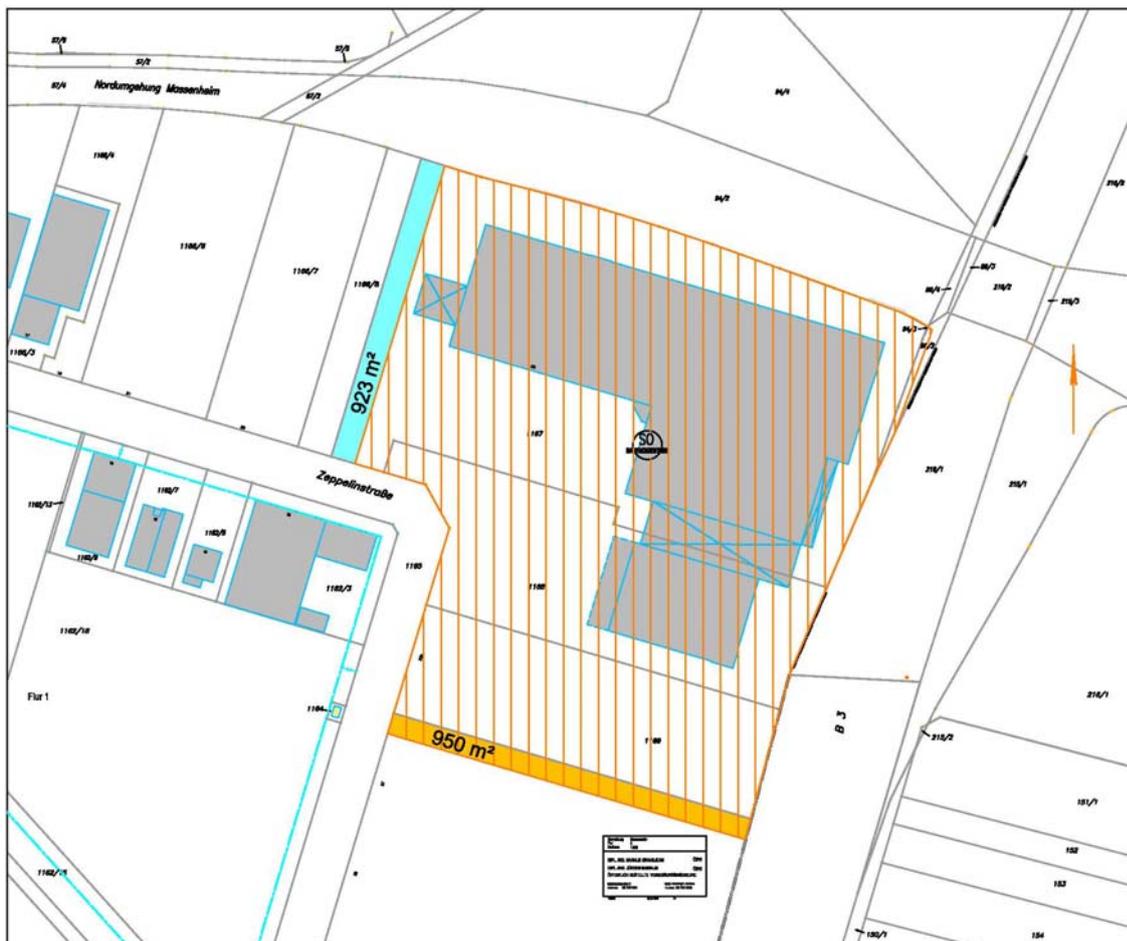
Tauschflächen und neu angekaufte Flächen als Grundlage der 5. Änderung
